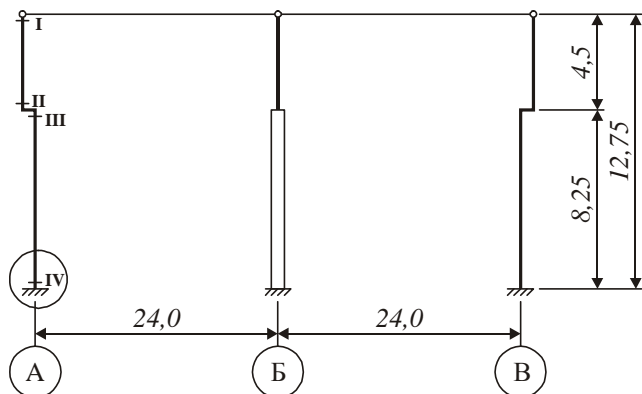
Расчетная схема двухпролетной рамы промышленного здания (исходные данные в примере 6.4 [8])
